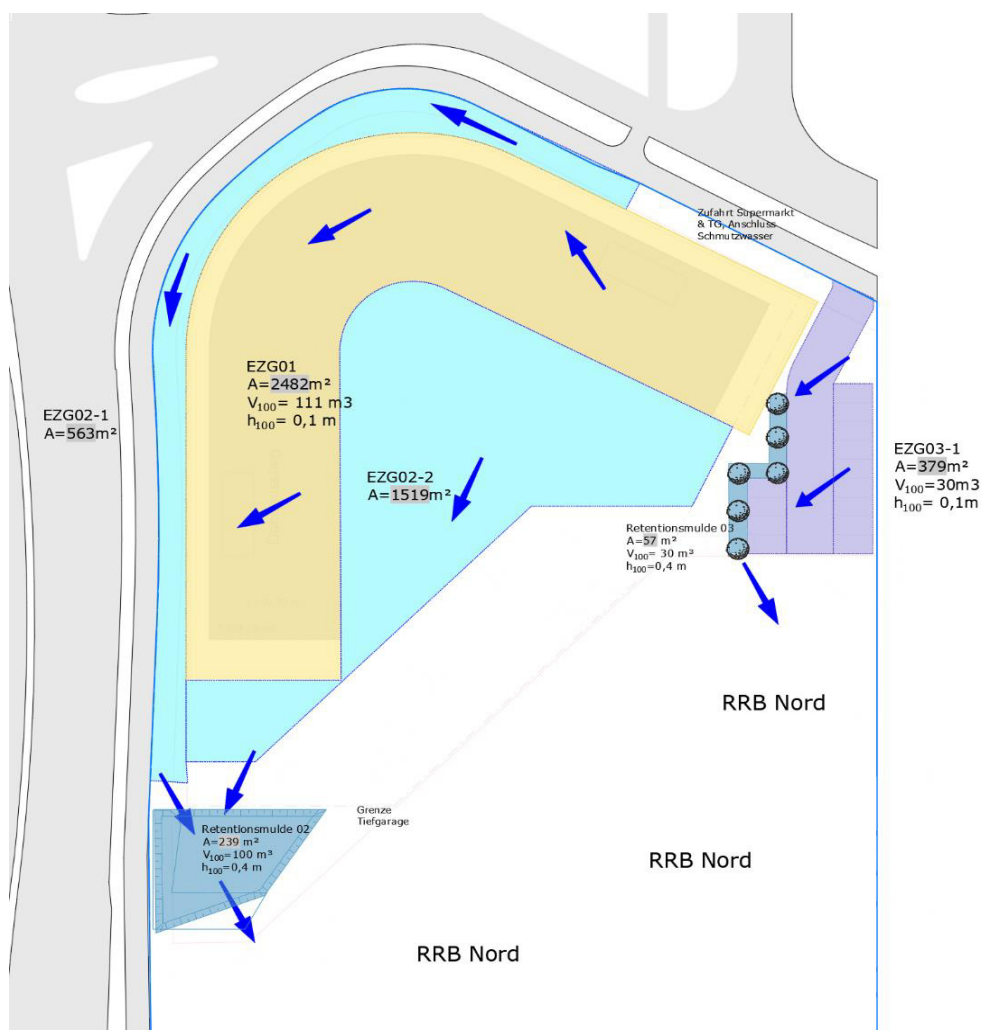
Ausschnitt Lageplan Entwässerung mit EZG
